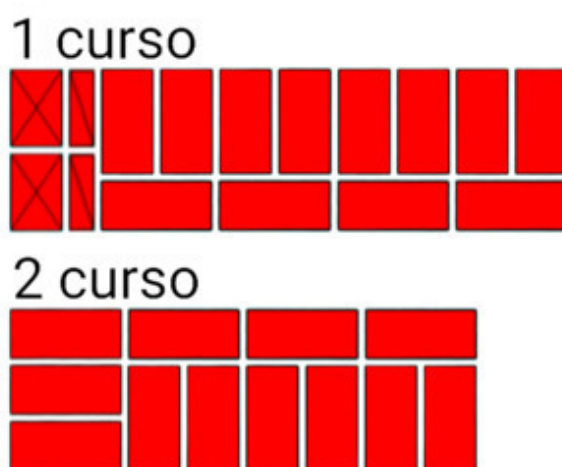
A ordem de colocação de tijolos na restrição vertical da parede de tijolos. Espessura da parede 1,5 tijolos.
